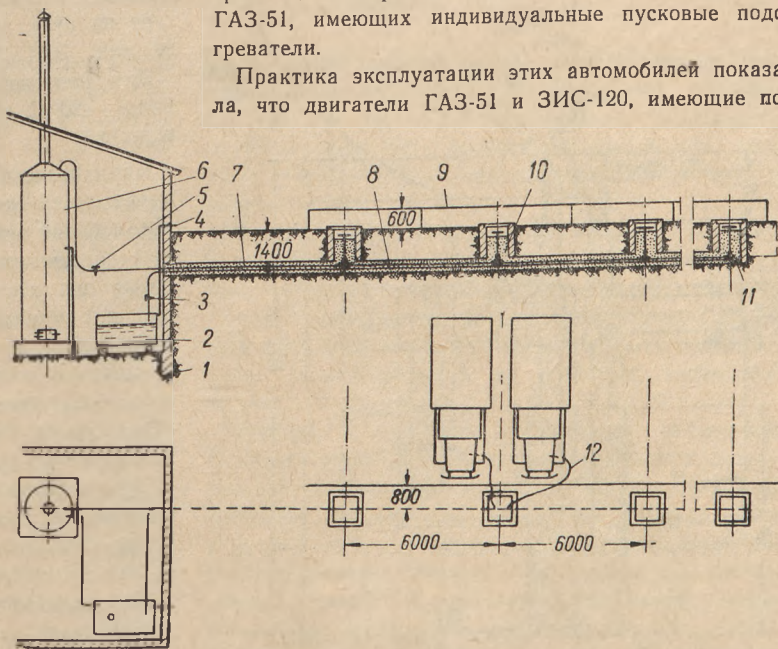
Схема площадки безгаражного хранения автомобилей, оборудованной пароподогревом:
